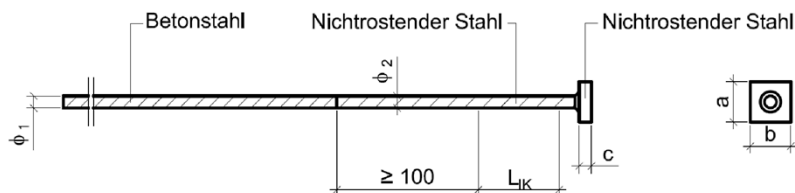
Druckelement aus Stahl mit angeschweißter Druckplatte und angeschweißtem Betonstahl
